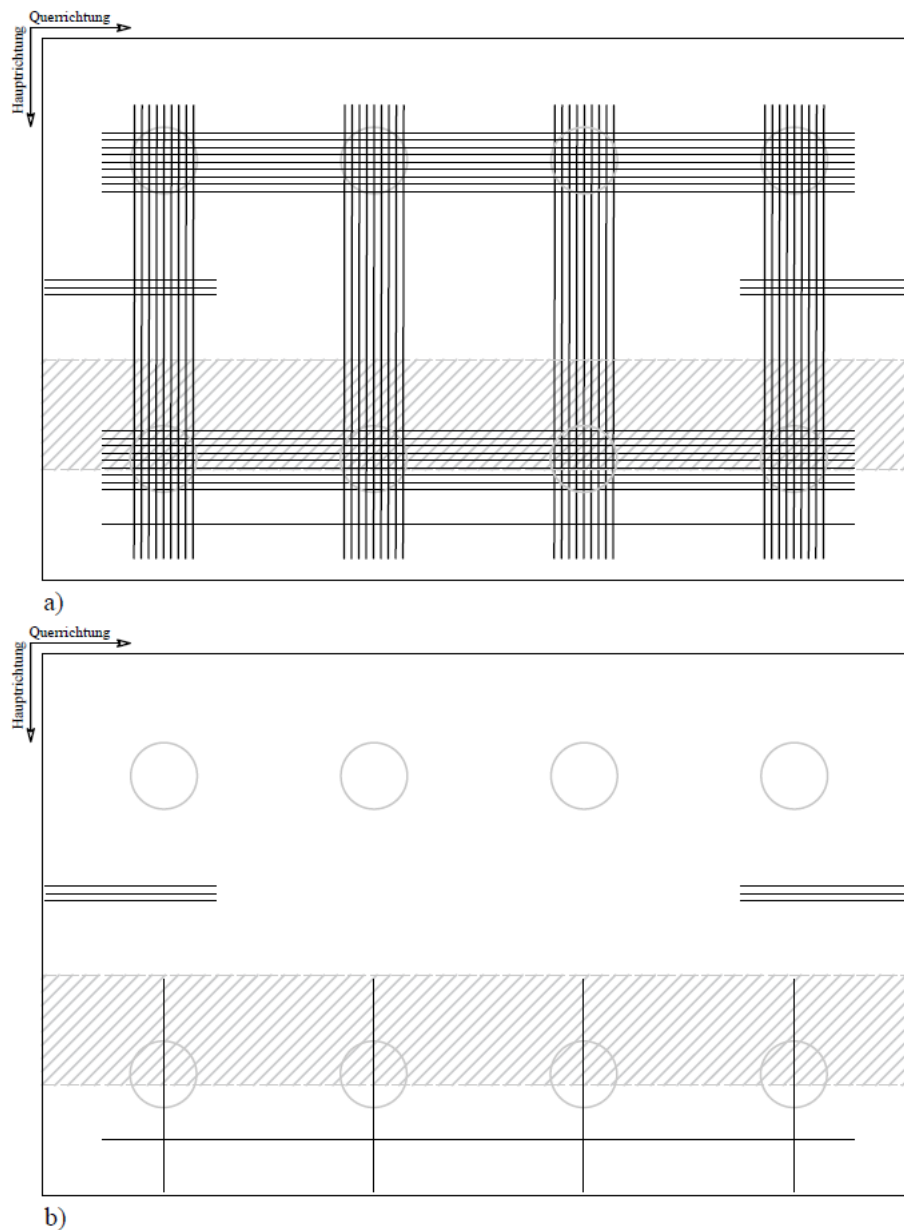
Variante 1 Lastfall 2 - a)Bewehrung unten, b)Bewehrung oben
